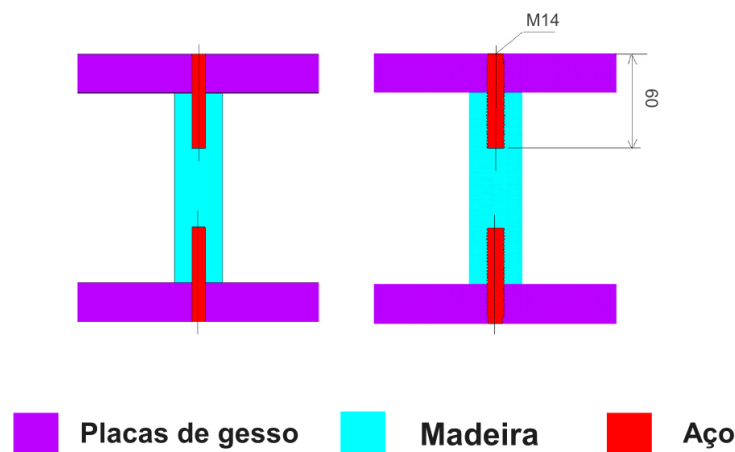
Parafusos de ligação entre placa de gesso e madeira
